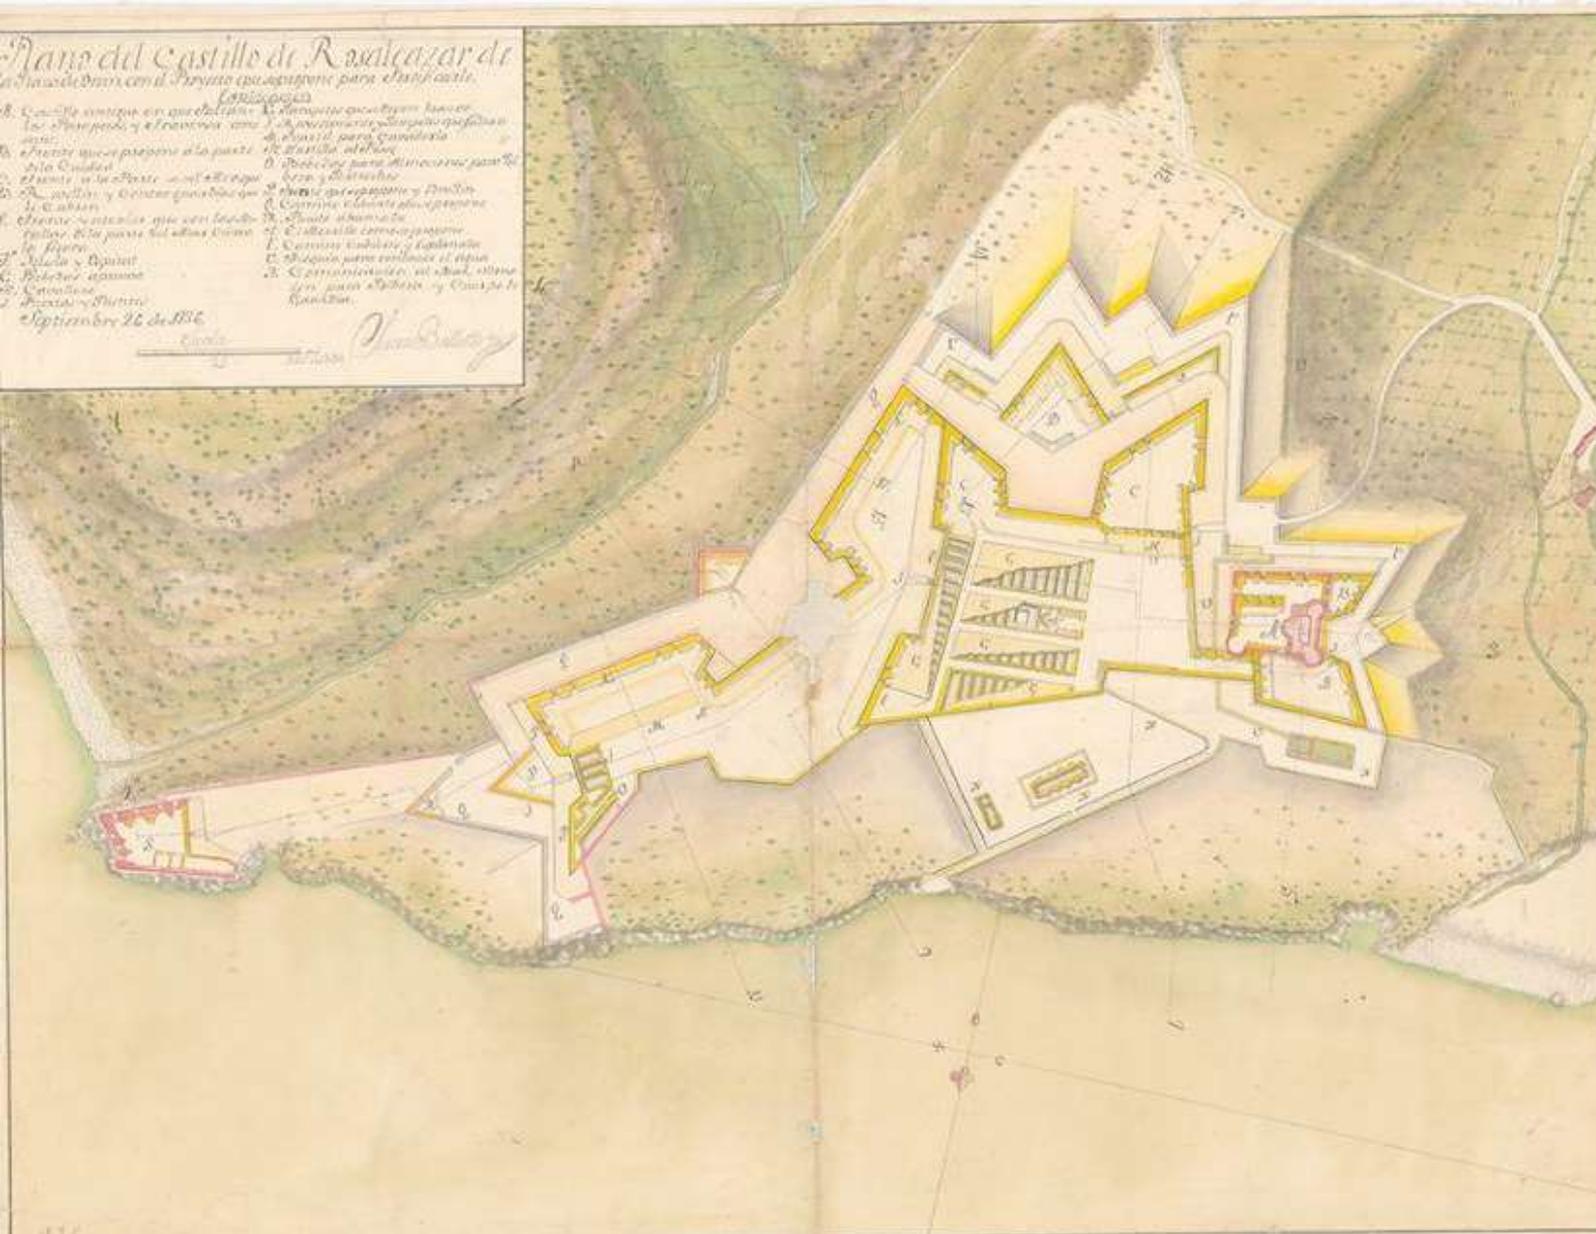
Plano de Rosalcazar en 1736 por Juan Ballester (SGE. 97ºbis).
